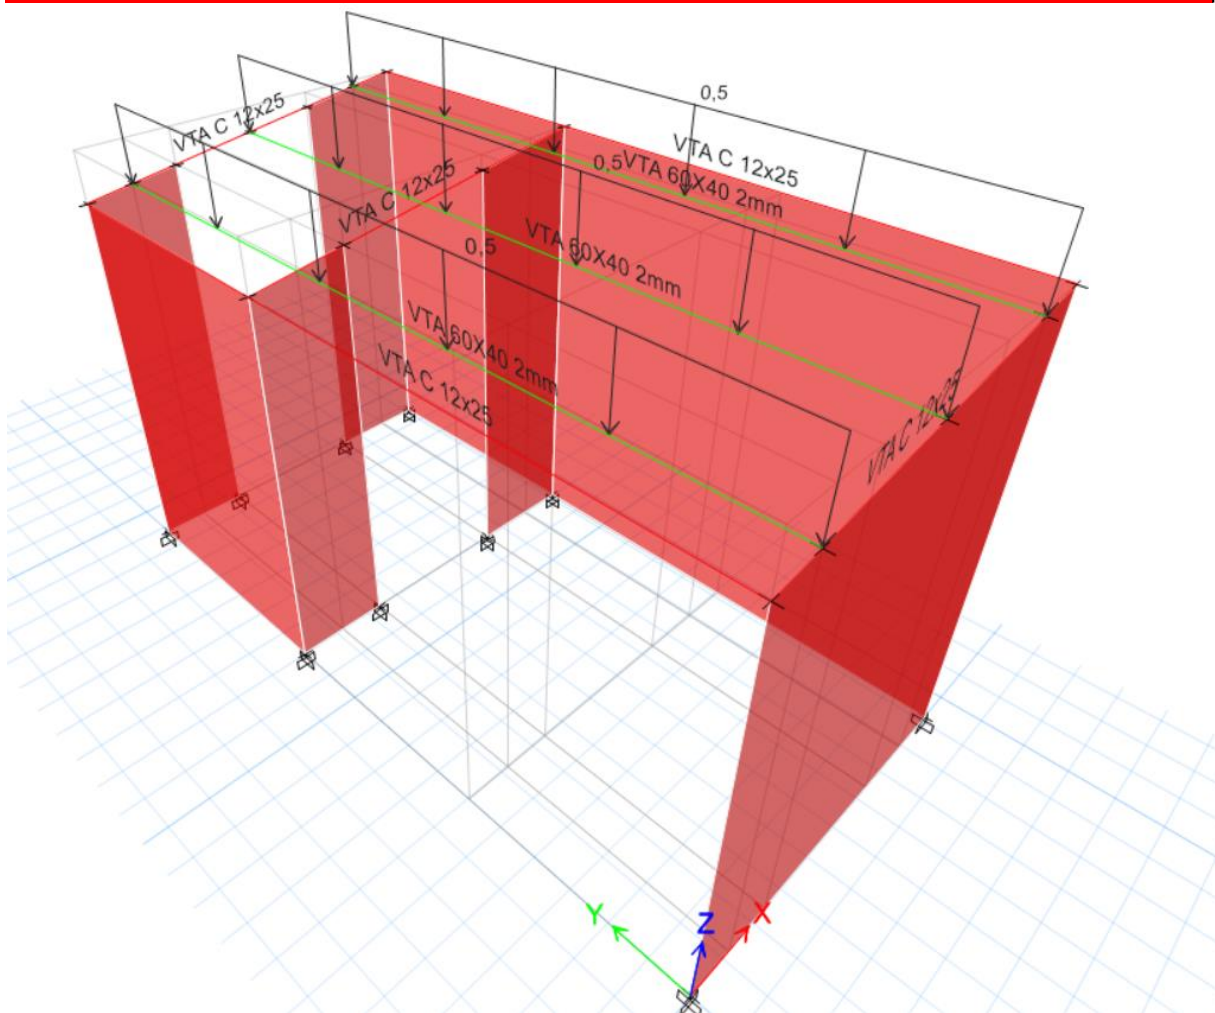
Carga Viva distribuida (W) [kN, m, C]
